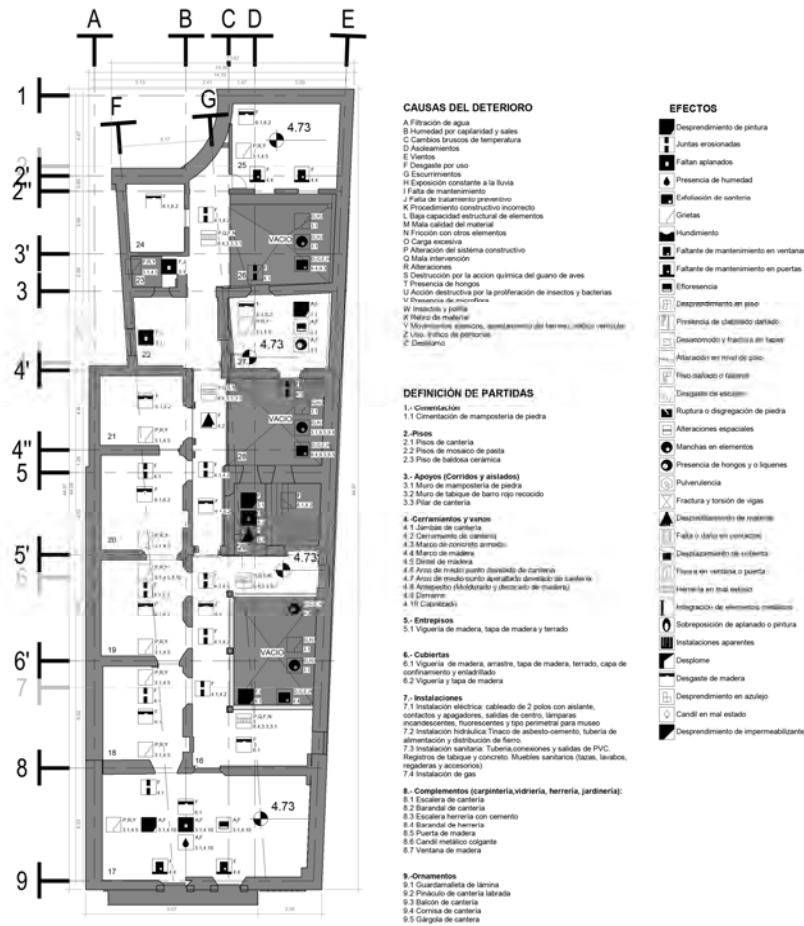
Simbología aplicada en los planos de registro de Alteraciones y Deterioros. Plano CAMEM AYD 101. Planta alta Elaboró: METR
